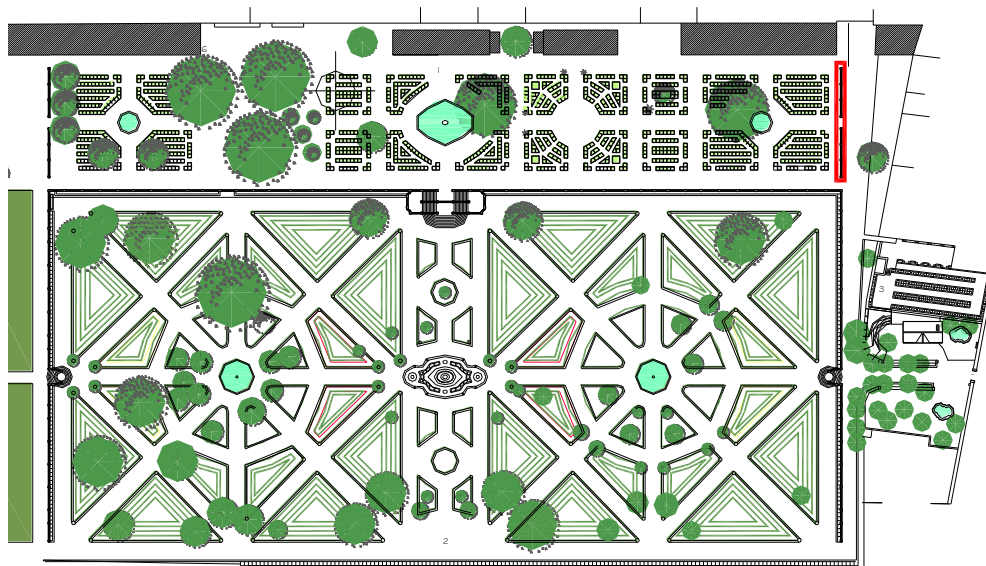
Planta do JBA. (Fonte: ISA/JBA)
